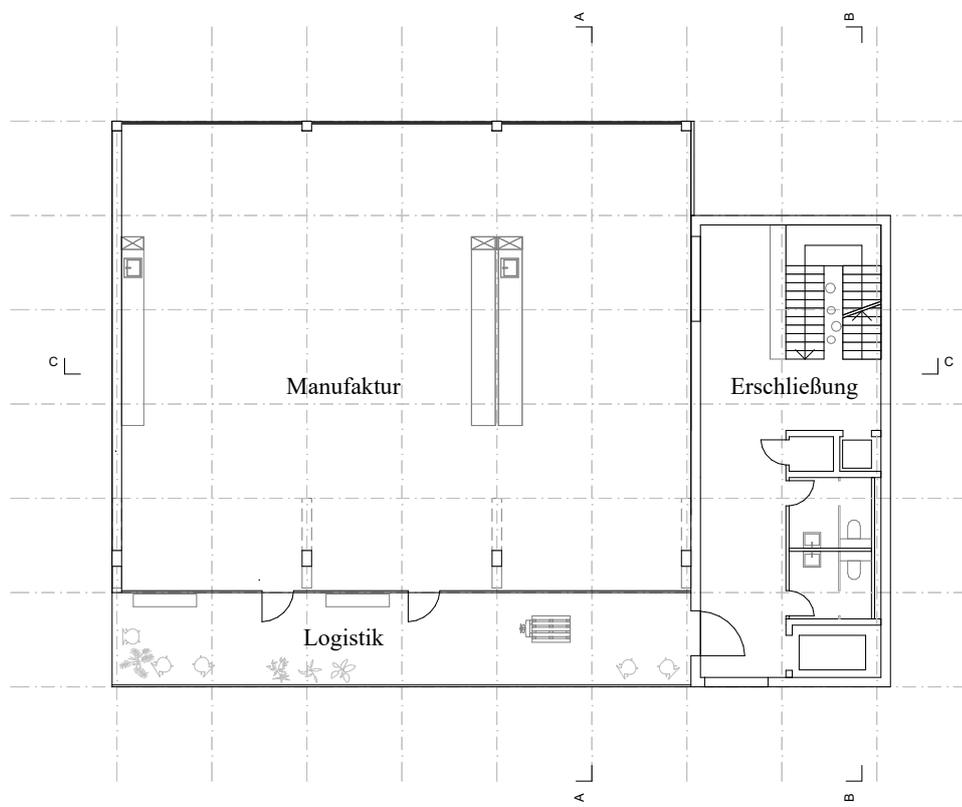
Grundriss Erstes Obergeschoss, M 1:250
